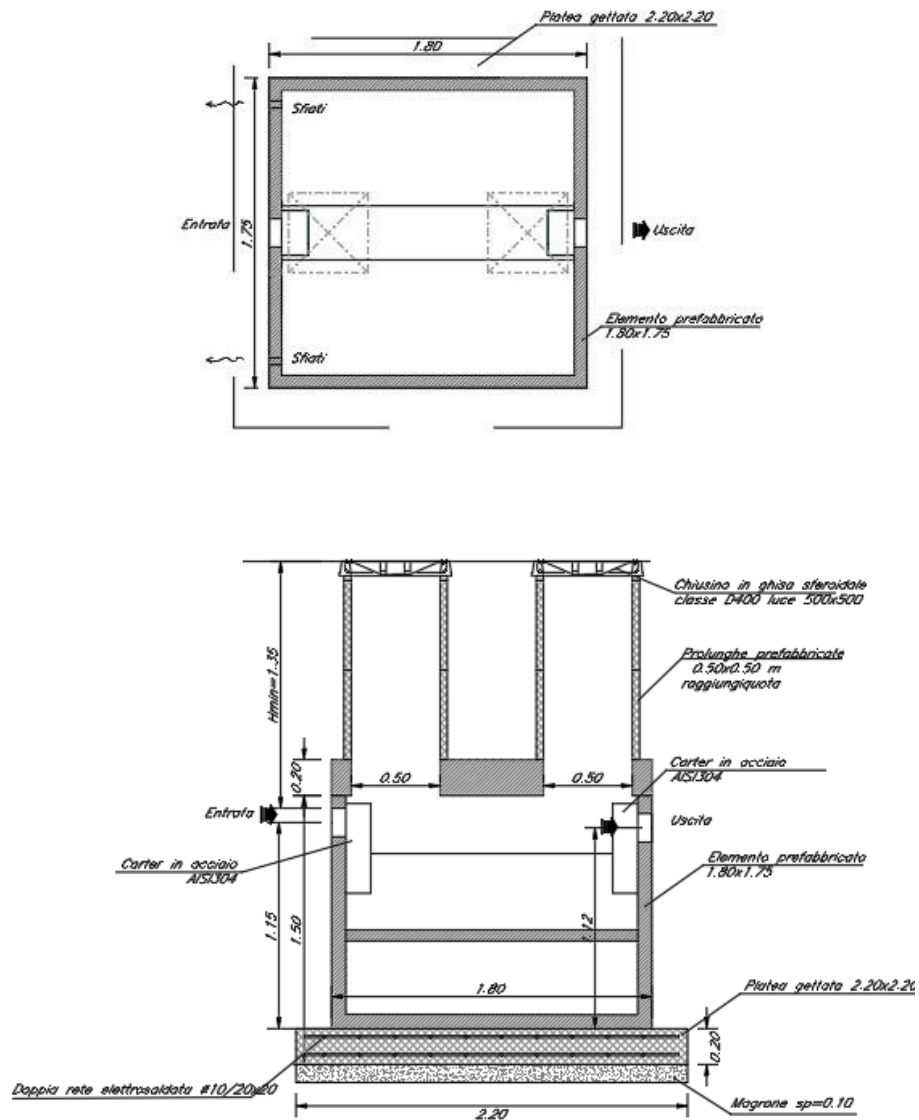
Vasca Imhoff – Pianta e Sezione
